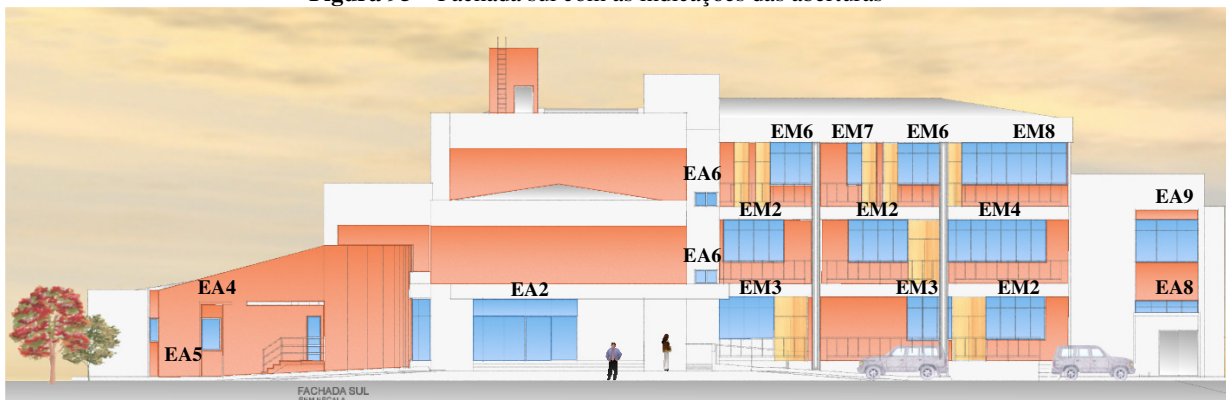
Fachada sul do bloco 1 com as indicações das aberturas
